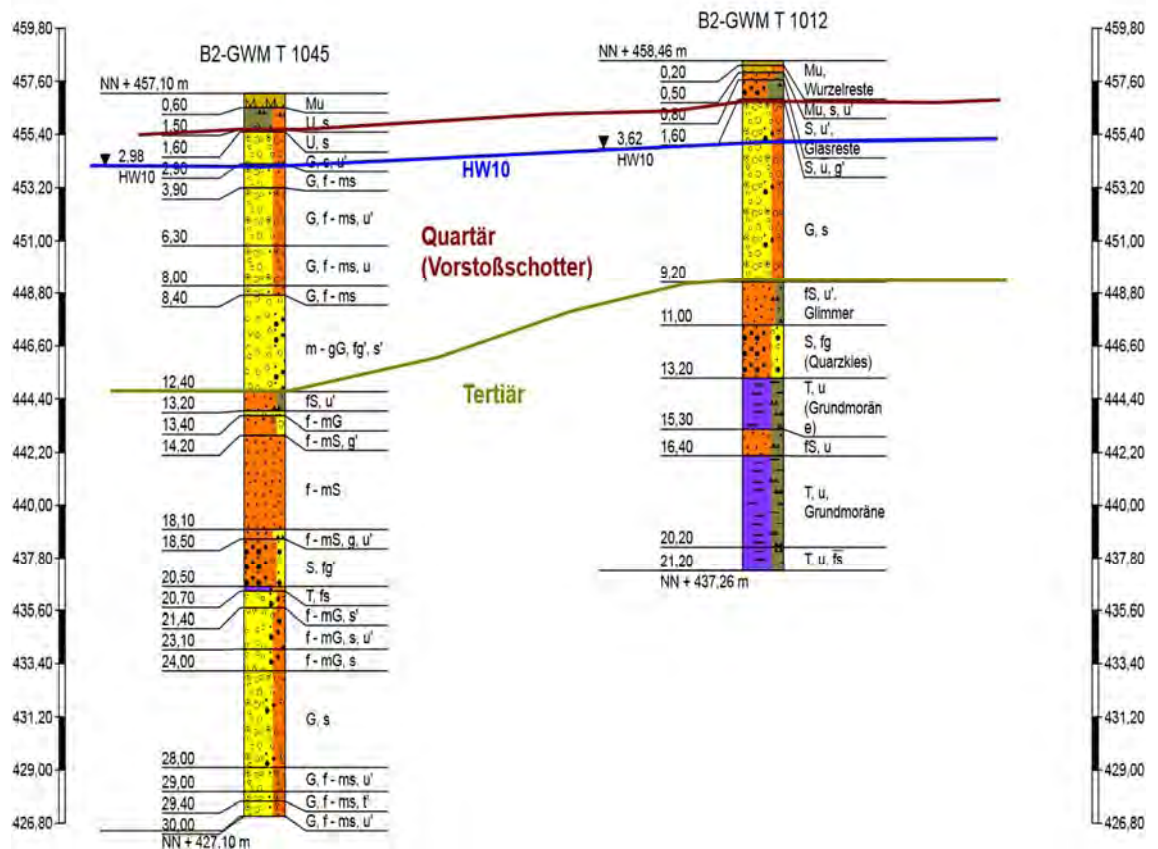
Untergrund im Bereich der geplanten Wiederversickerung der Bauwasserhaltung
